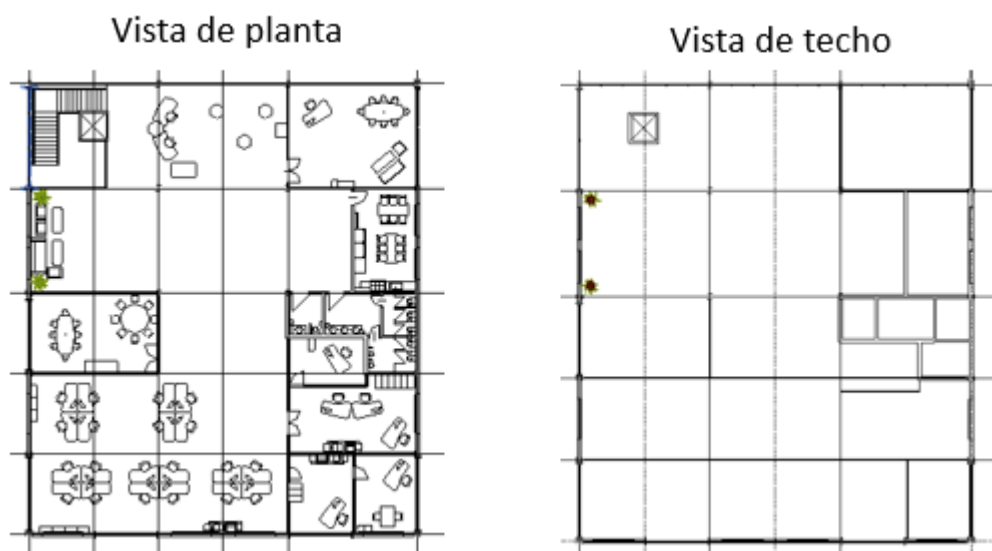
Comparativa entre plano de planta y plano de techo para la primera planta.
